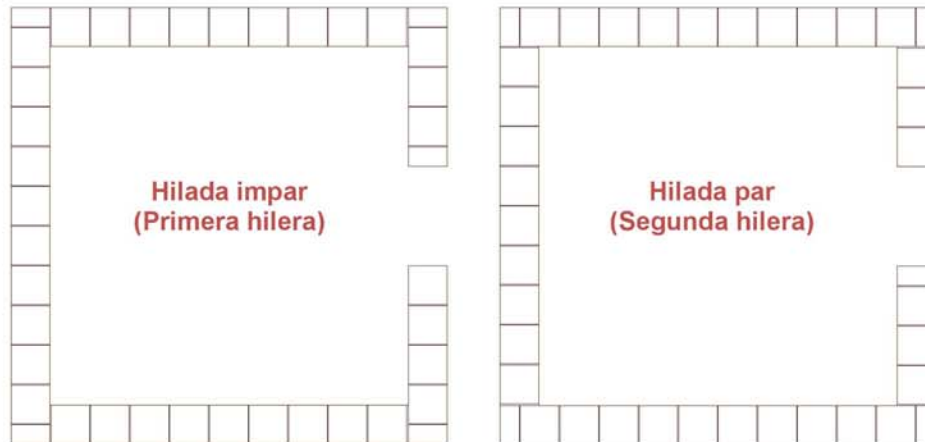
Emplantillado de hilada impar (izquierda) y par (derecha)
